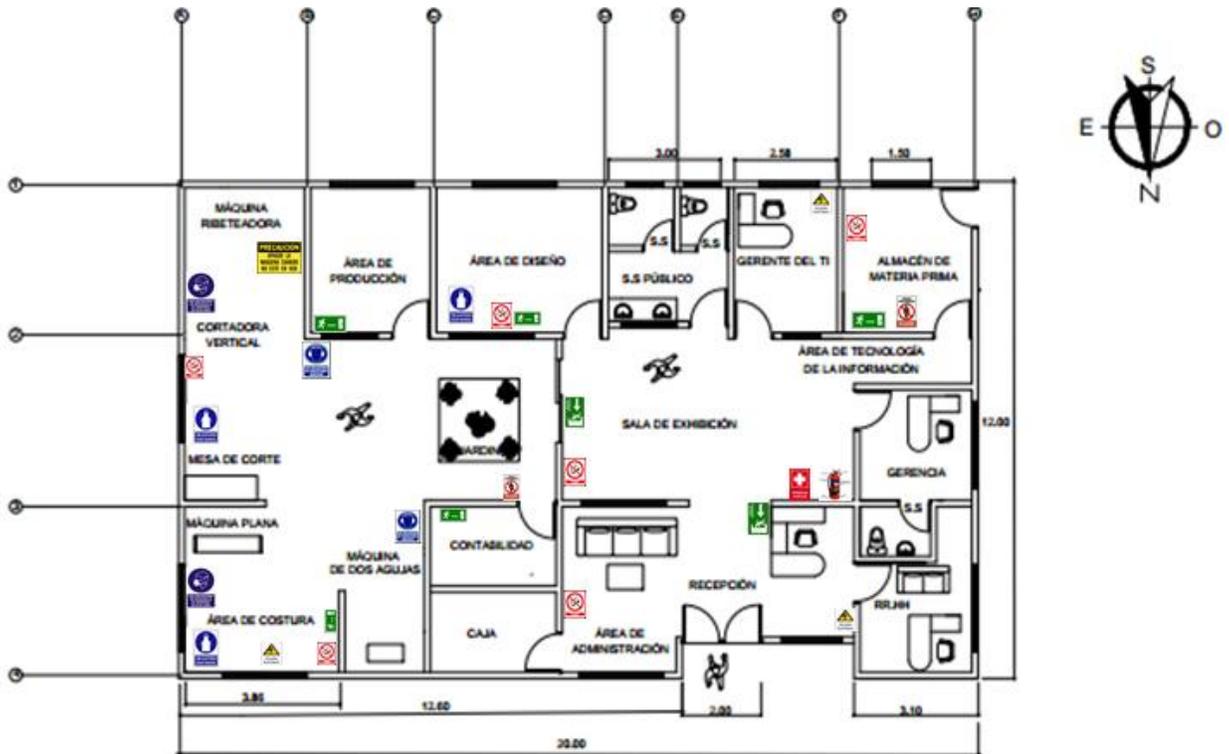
Plano Arquitectónico con señalización. Elaboración Propia.
